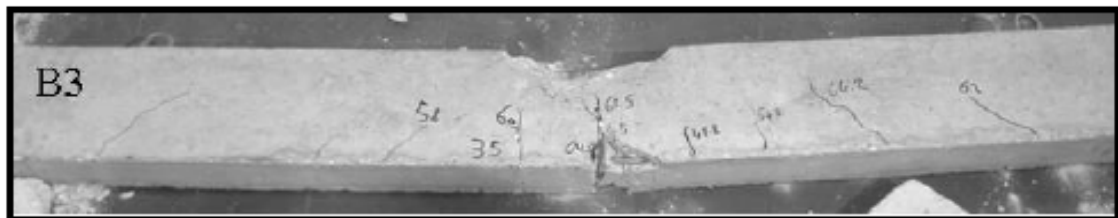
FISSURAÇÃO E MODO DE FALHA: AL-ZAHRAA; EL-MIHILMY; BAHAA, (2010)
